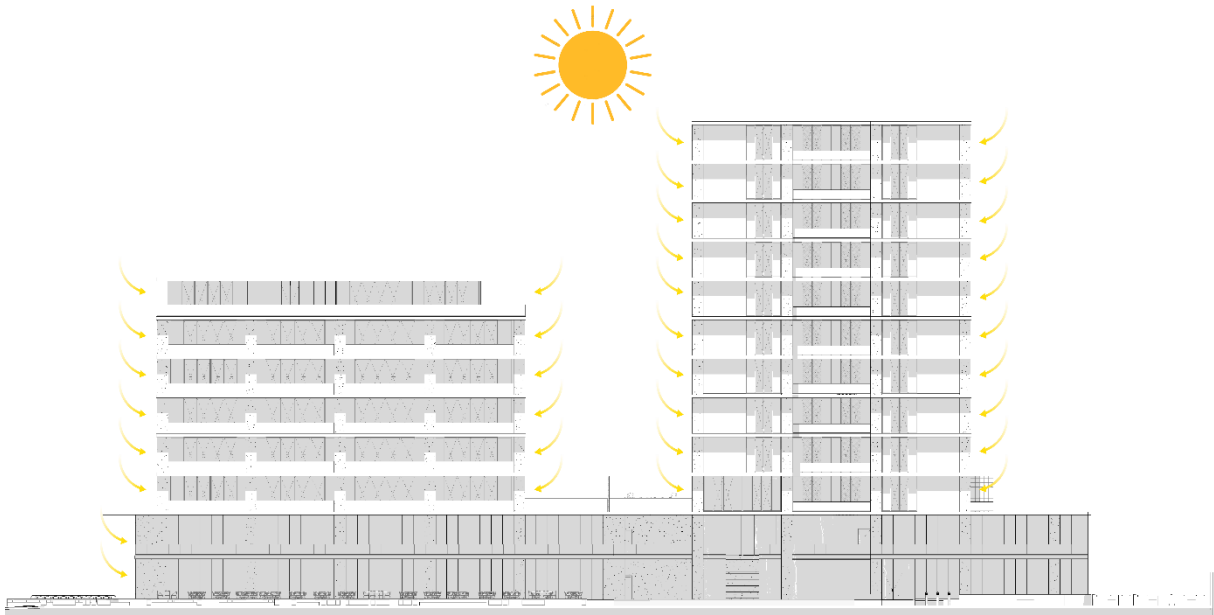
Entrada de iluminación natural en las fachadas del proyecto
